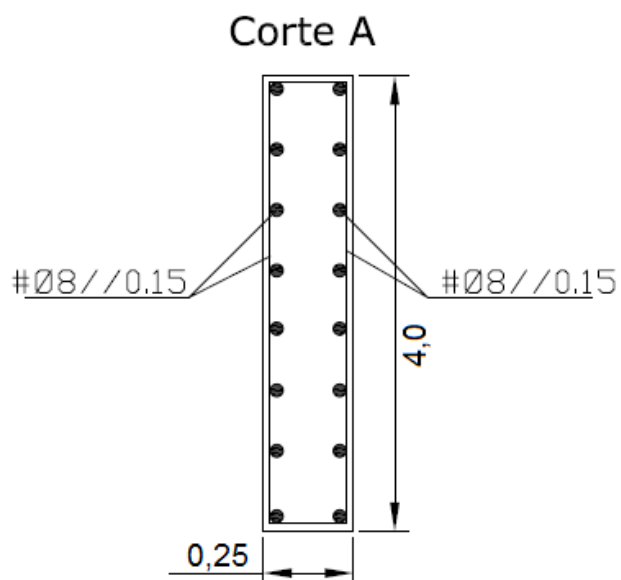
Desenho das armaduras segundo o corte transversal A.
